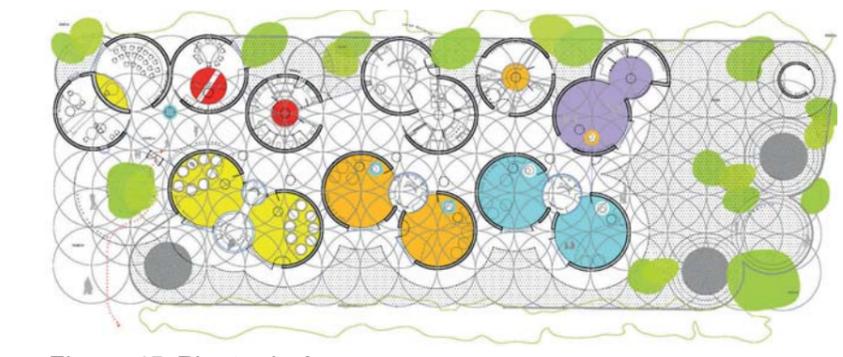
Planta de Acceso. Tomado de (Pizado y de Blas, 2007)
